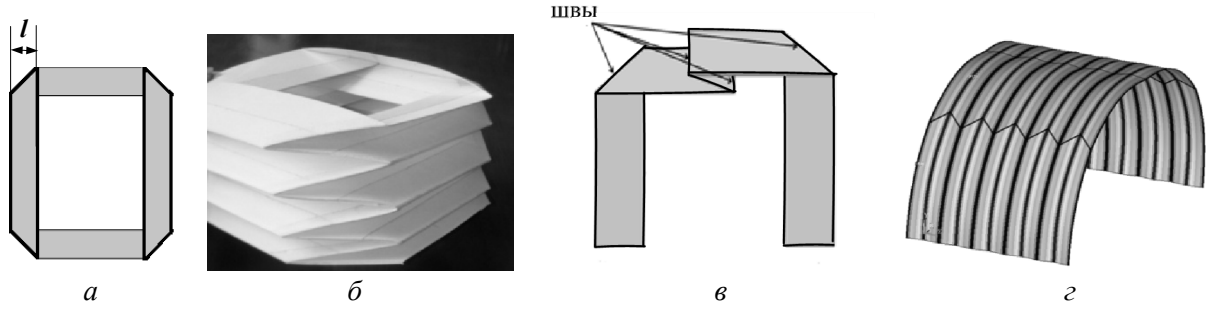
Составной элемент оболочки (а); оригами цилиндрической оболочки в упакованном виде (б); закладка дополнительного долевого шва (в); половина развернутой 10-полосной конструкция (г)
